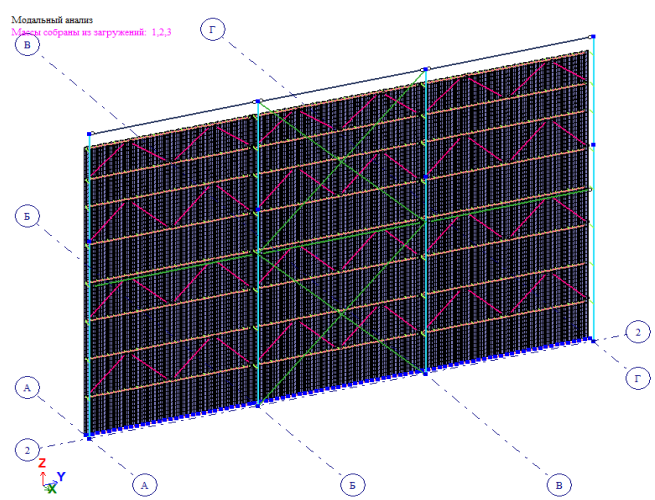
Расчетная схема стены с учетом элементов усиления
